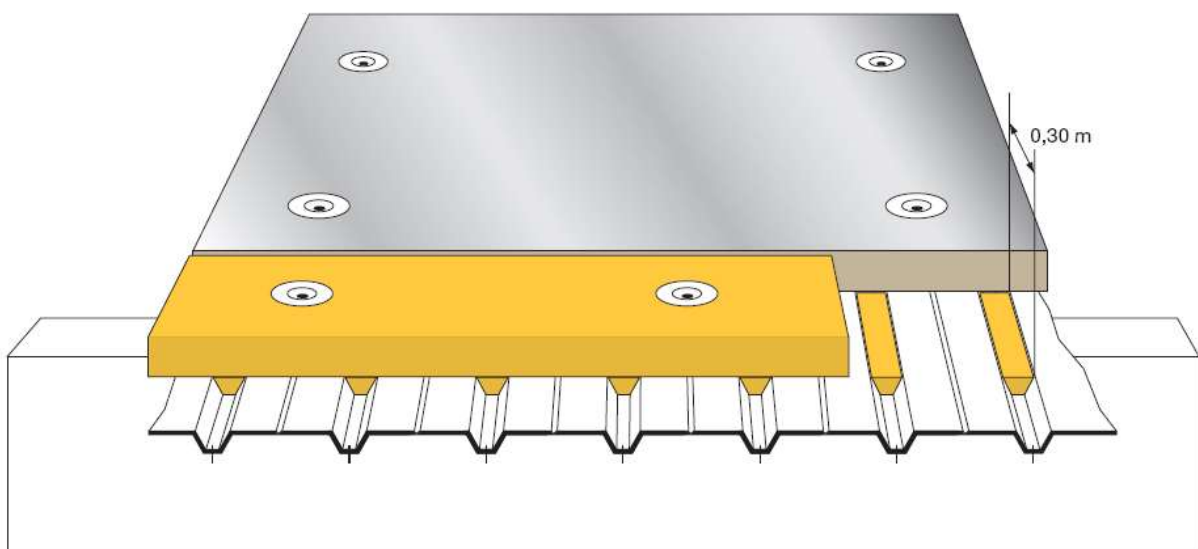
POWERDECK+ en ERP sans écran thermique (pose en 1 lit) : Exemple de recouvrement au droit d'un mur ou d'un écran de cantonnement perpendiculaire aux ondes
